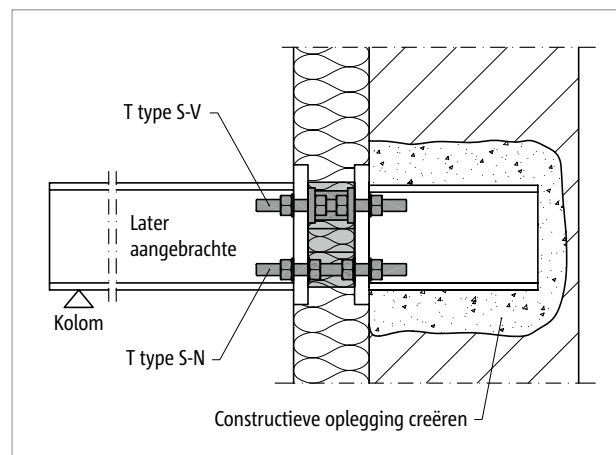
Schöck Isokorb® T type S-N en T type S-V: Aansluiting staalconstructie op een betonnen constructie
